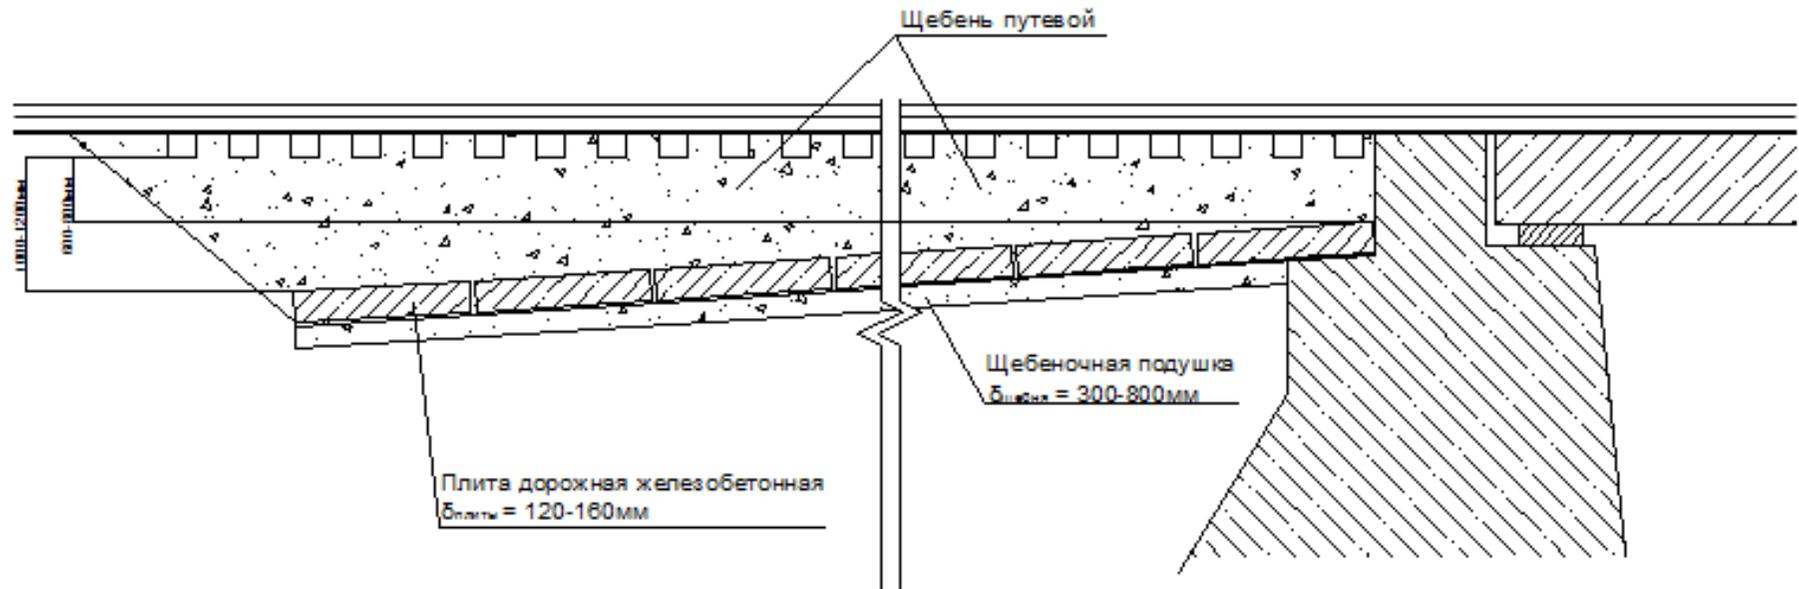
Конструкция сопряжения с насыпью для участков со скоростями движения поездов до 200 км/ч в виде наклонной сборной железобетонной плиты.
